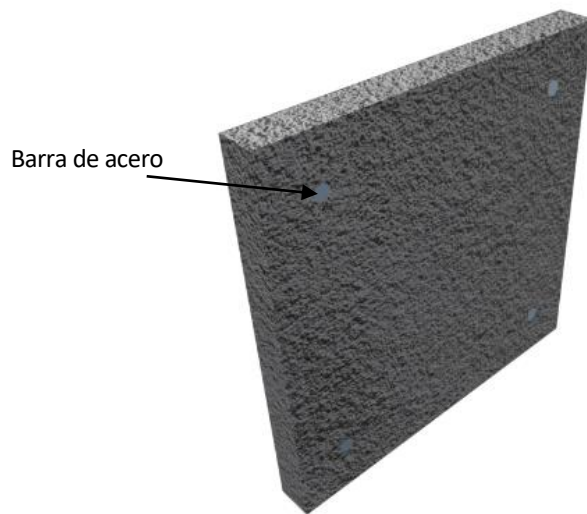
Sección de la columna de hormigón armado de dimensiones 300x300 milímetros.
